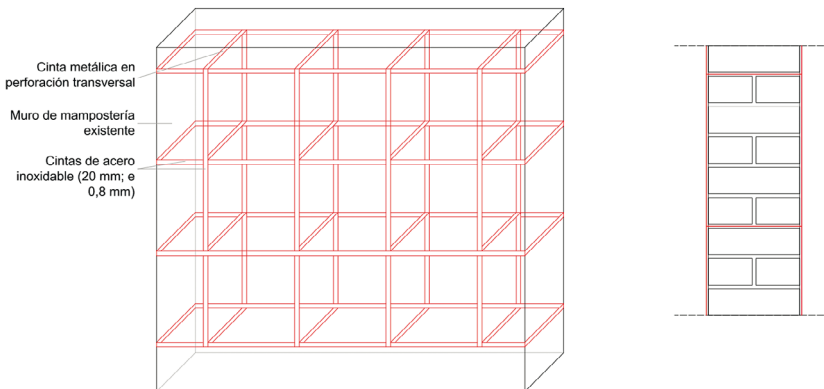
Sistema de atado tridimensional. Esquema y detalle constructivo.
